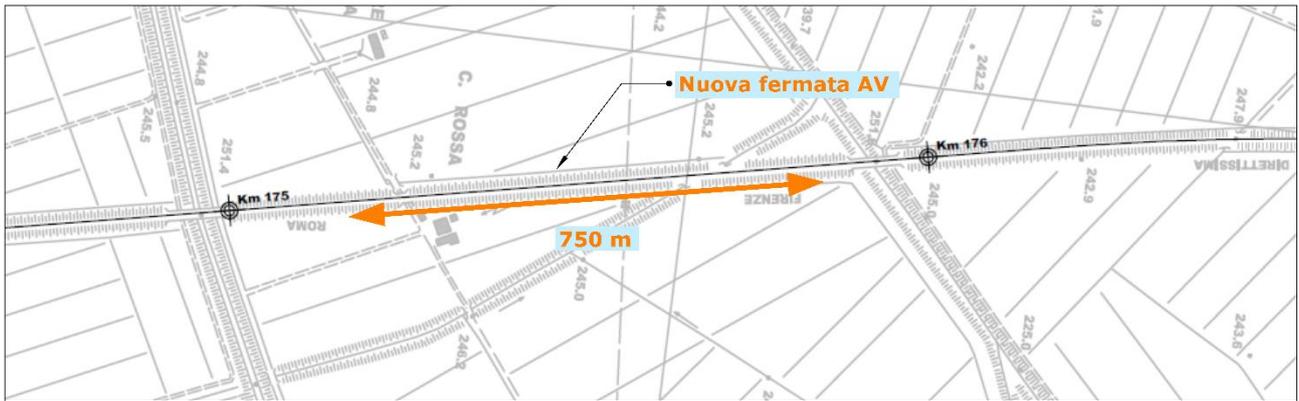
B. Planimetria della tratta Bettolle Creti, compresa tra le progressive pk 174+955 e 176+050. Fonte: RFI, tavola L514 - Km154 – 189.
